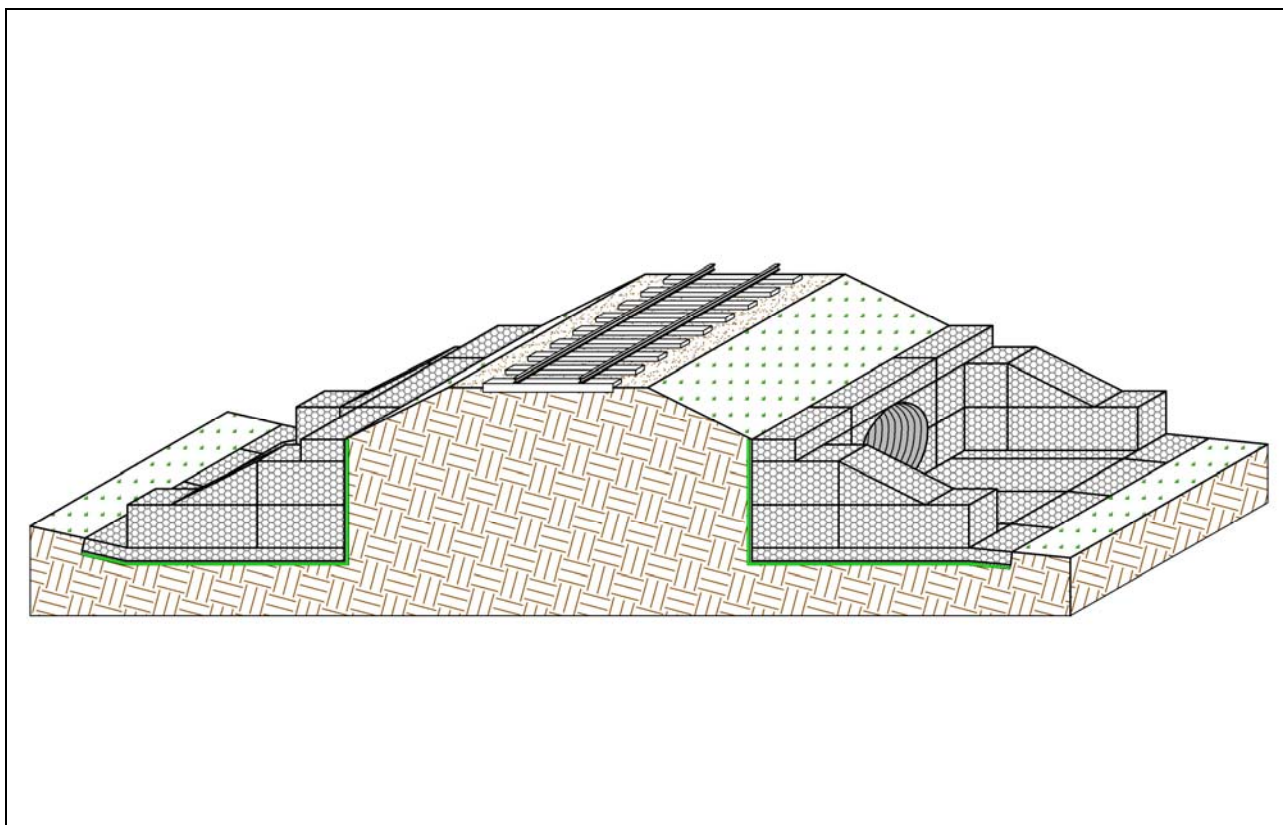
(продолжение) Укрепление оголовков водопропускной трубы открьлками из габиионных конструкций
